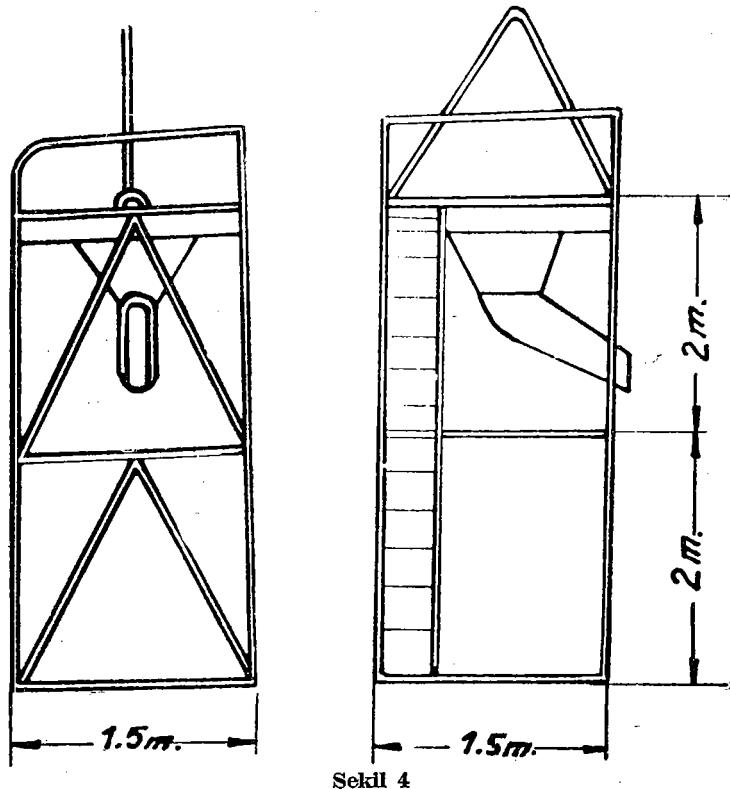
de bileziklerden birinin betonunun dökülübü görülmektedir. Beton, 240 platformuna (Resim 7) de görülen kamyonla bindirilmiş betonyer vasıtasiyle santiyenin merkezi beton fabrikasından getirilmiştir. Kamyondan beton kovasına alınan beton, kulevinci vasıtasiyle denge bacasına indirilmektedir. Beton kovasının bir manivela ile açılıp kapatılan bir dip kapağı vardır. Beton, kovadan (Resim 5 ve Şekil 4) de görülen üç katlı beton asansörünün beton silosuna boşaltılır. Silonun altında 360° dönen bir eğik oluk var-
